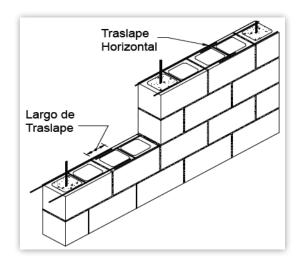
Muros reforzados Fuente. https://www.researchgate.net/figure/Figura-24-Empalme-por-traslape-de-escalerillas-electrosoldadas-Largode-traslape-para_fig2_326814305
